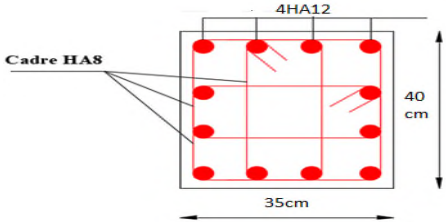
Schéma de ferrailage des poteaux étages 4 et 5
